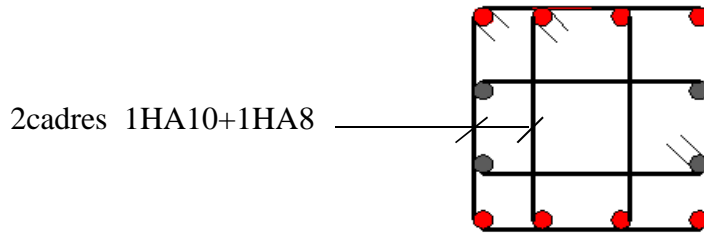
Armatures transversales des Poteaux des Niveaux RDC à 2
